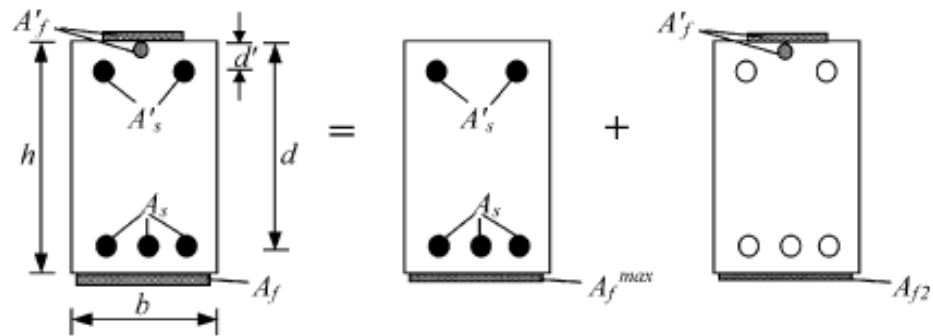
Section rectangulaire avec armatures comprimées, double renforcée par CFRP
